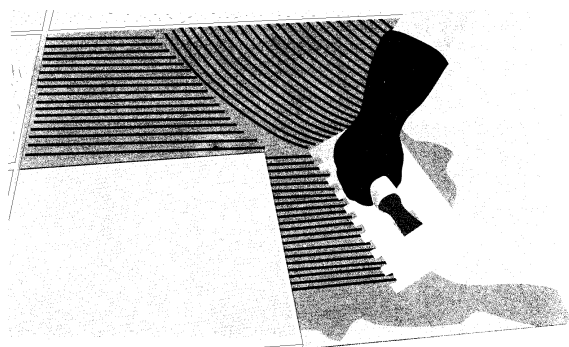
Aplicação do lado dentado da desempenadeira formando cordões
